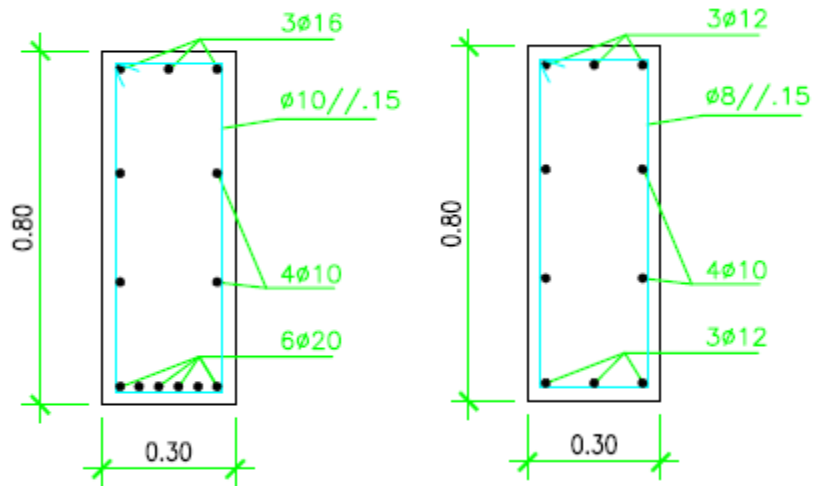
Viga VC2 do lado esquerdo e viga VC3 do lado direito
